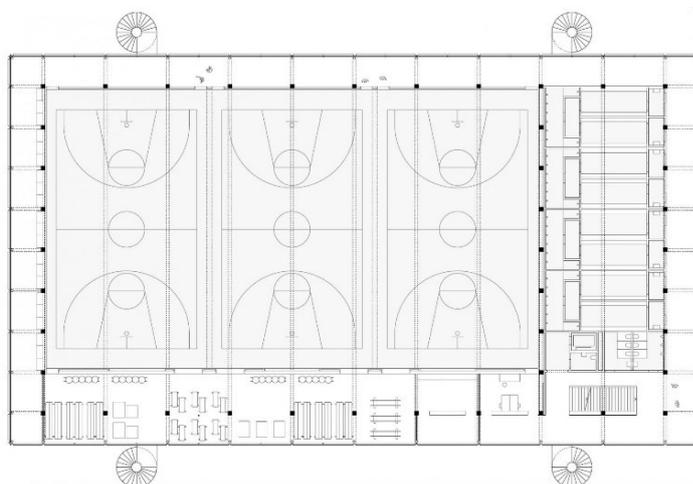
Grundriss 2.OG Siegerprojekt
